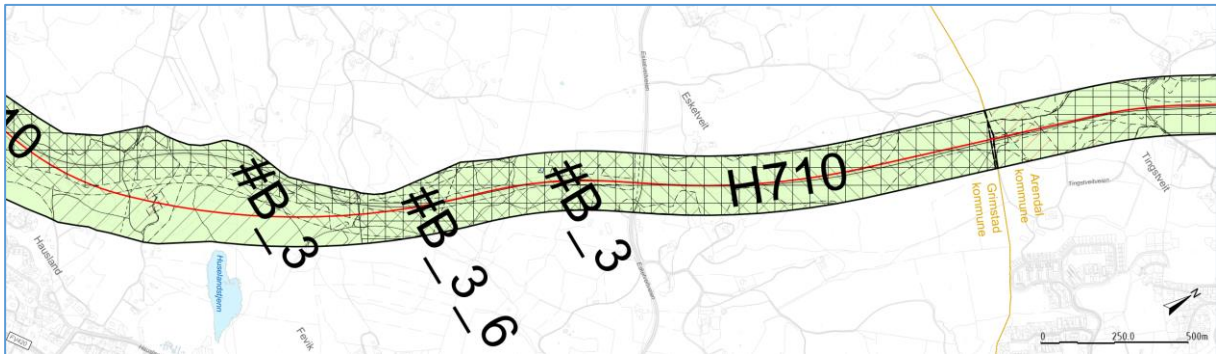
Forslag til endret kommunedelplan på delstrekning Lunderød-Tingstveit. (Kilde: Sweco)
